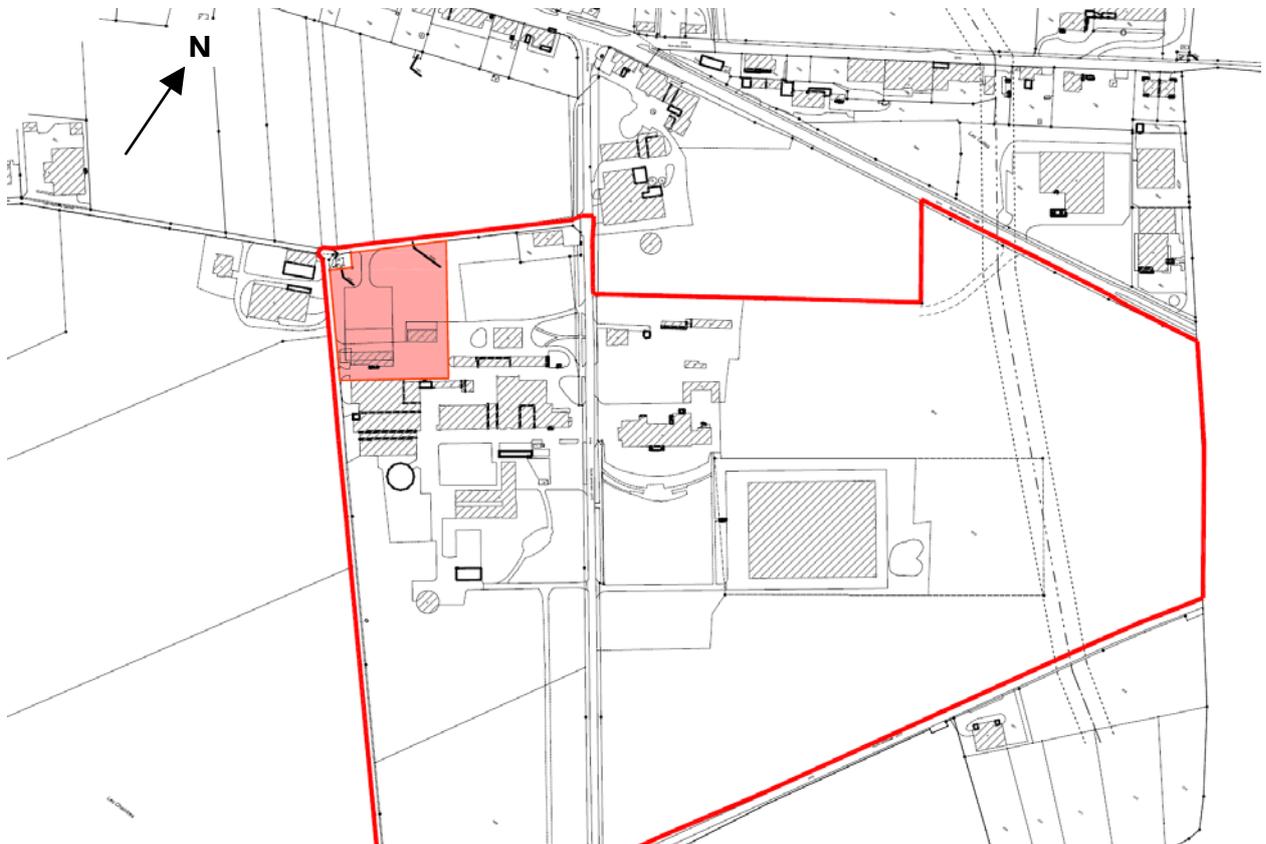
Plan de situation. Trait rouge : périmètre du plan spécial. Surface rouge : zone concernée par la modification.
